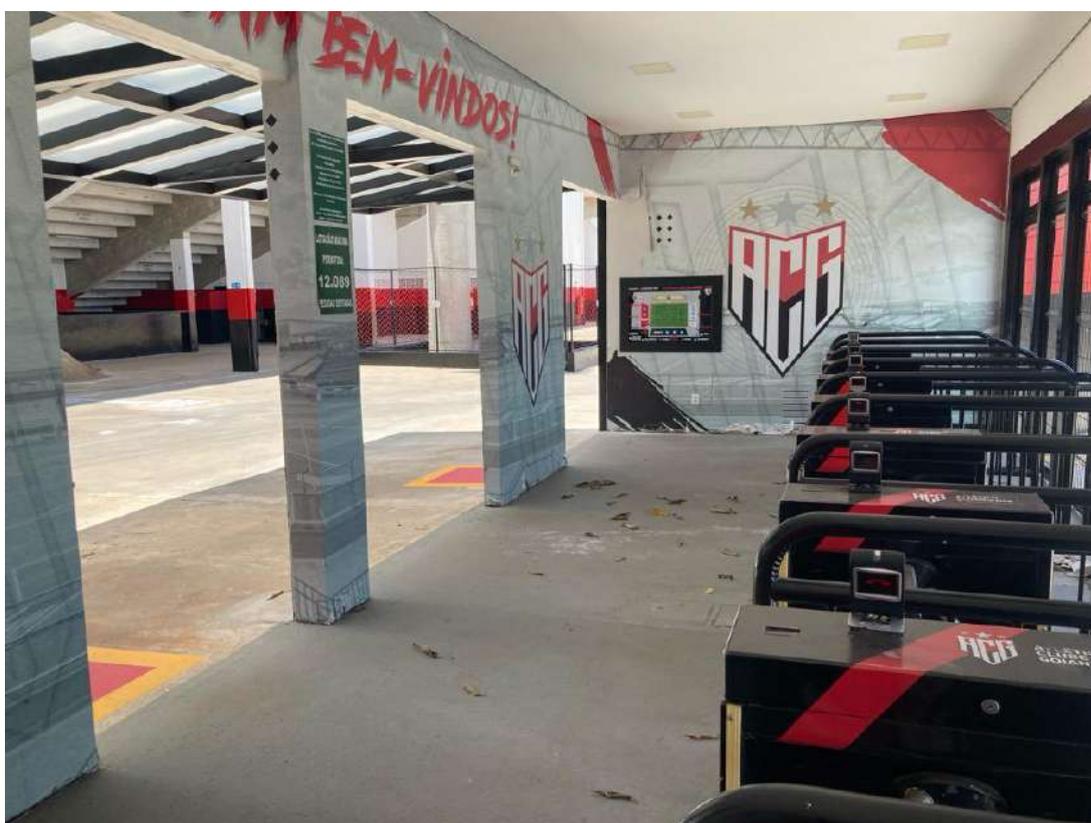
Vista interna da Entrada Norte - sem sinais visíveis de desconformidade estrutural
